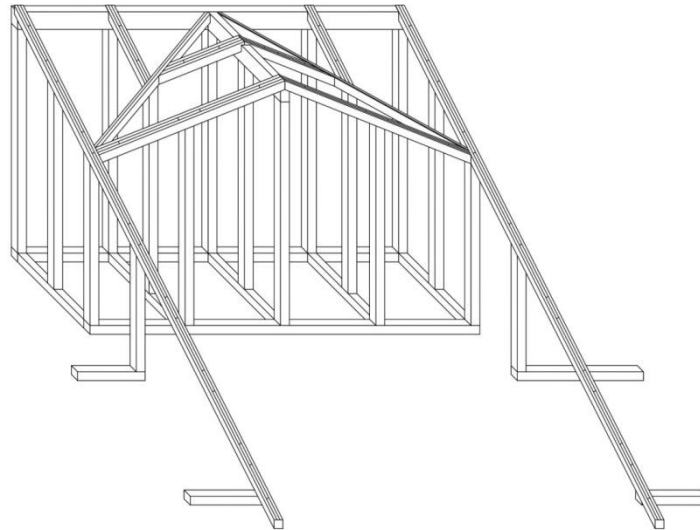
Стропильная конструкция первого варианта крыши на примыкании к башне
